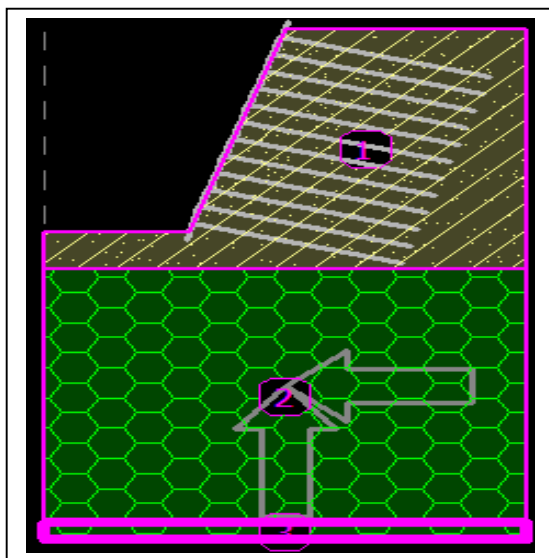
Talus droit à l'entrée du tunnel avec soutènement
